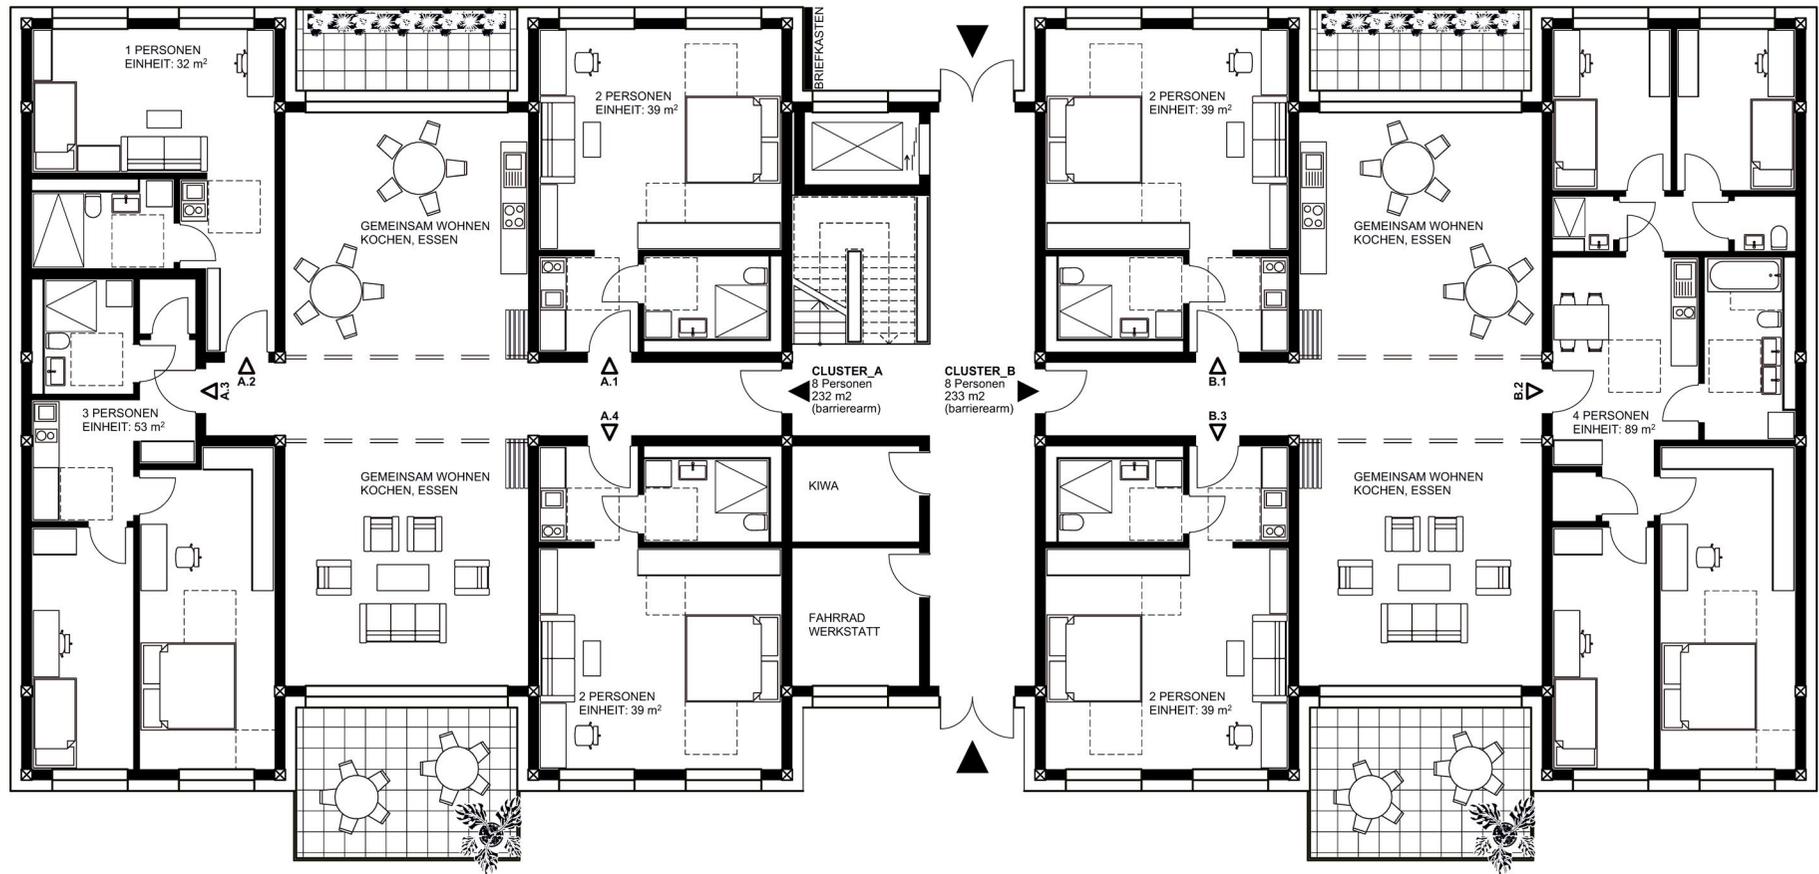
Erdgeschoss | M 1:175 | nbg+ neuberger+genze architekten mbb (Nürnberg)
